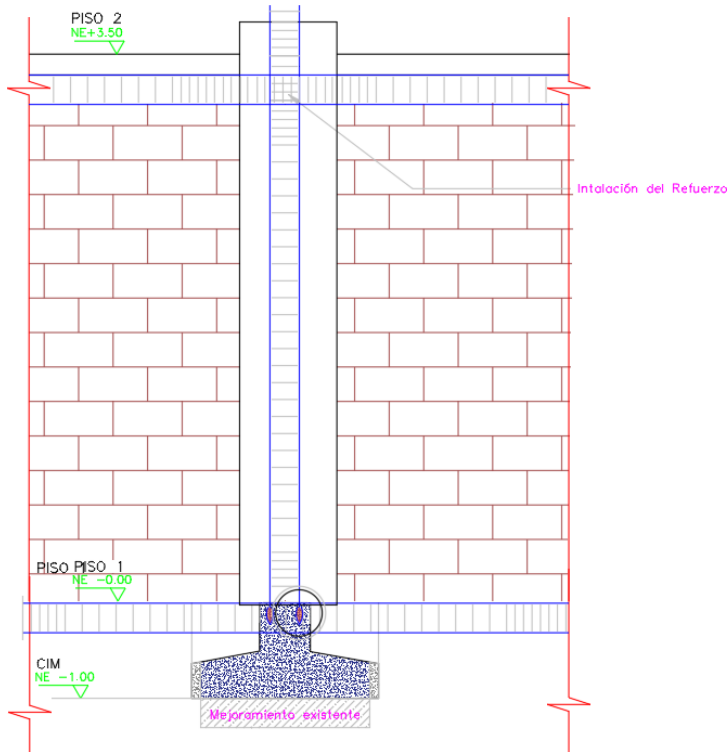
Instalación de Refuerzo, Formaleta y Vaciado del Concreto en Vigas.
